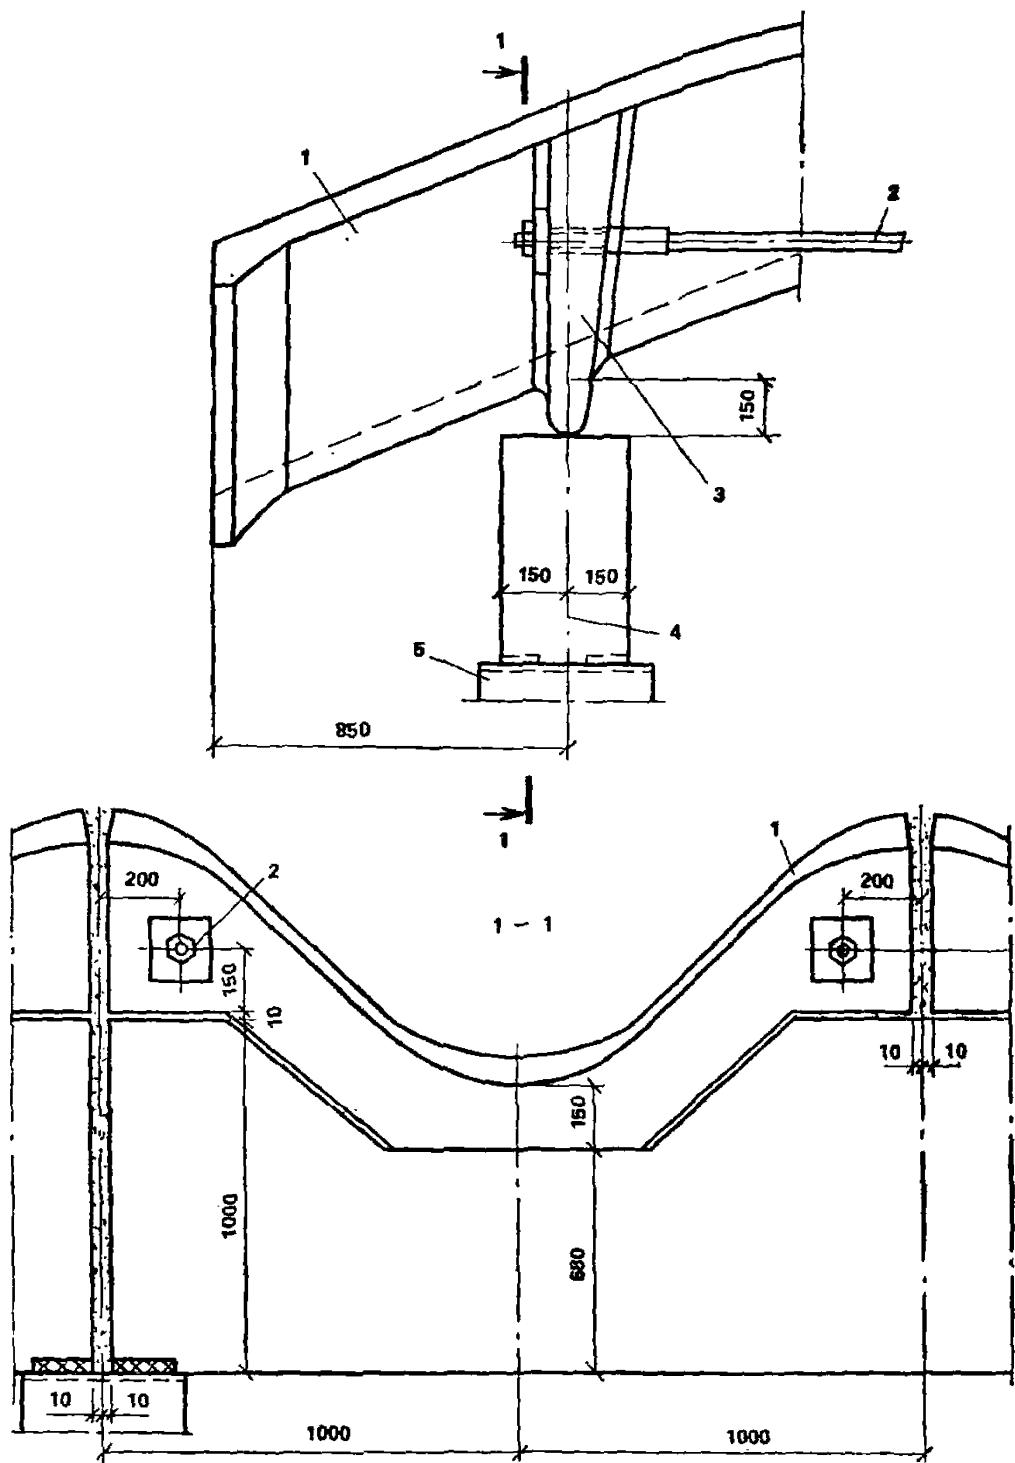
Узел опирания большепролетных сводчатых покрытий из армоцементных элементов на подстропильные балки
